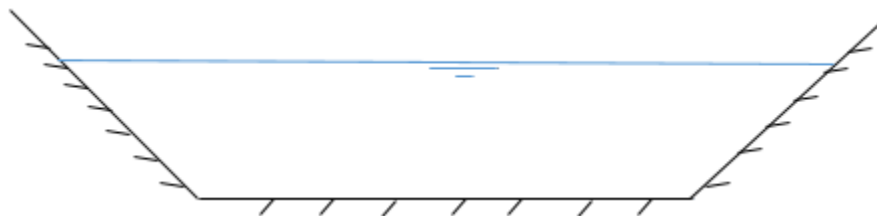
Geometría trapezoidal de un canal (Fuente: Elaboración propia).
